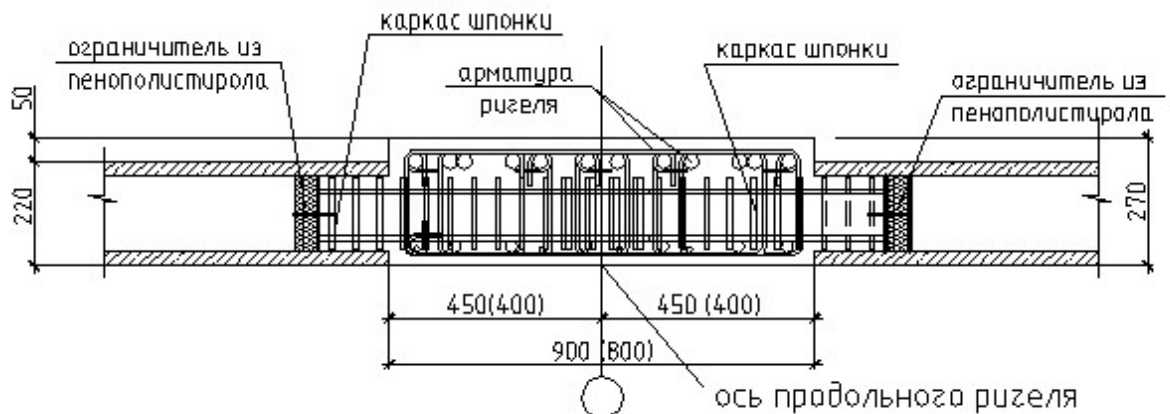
Вузол приєднання ригеля до плити перекриття
